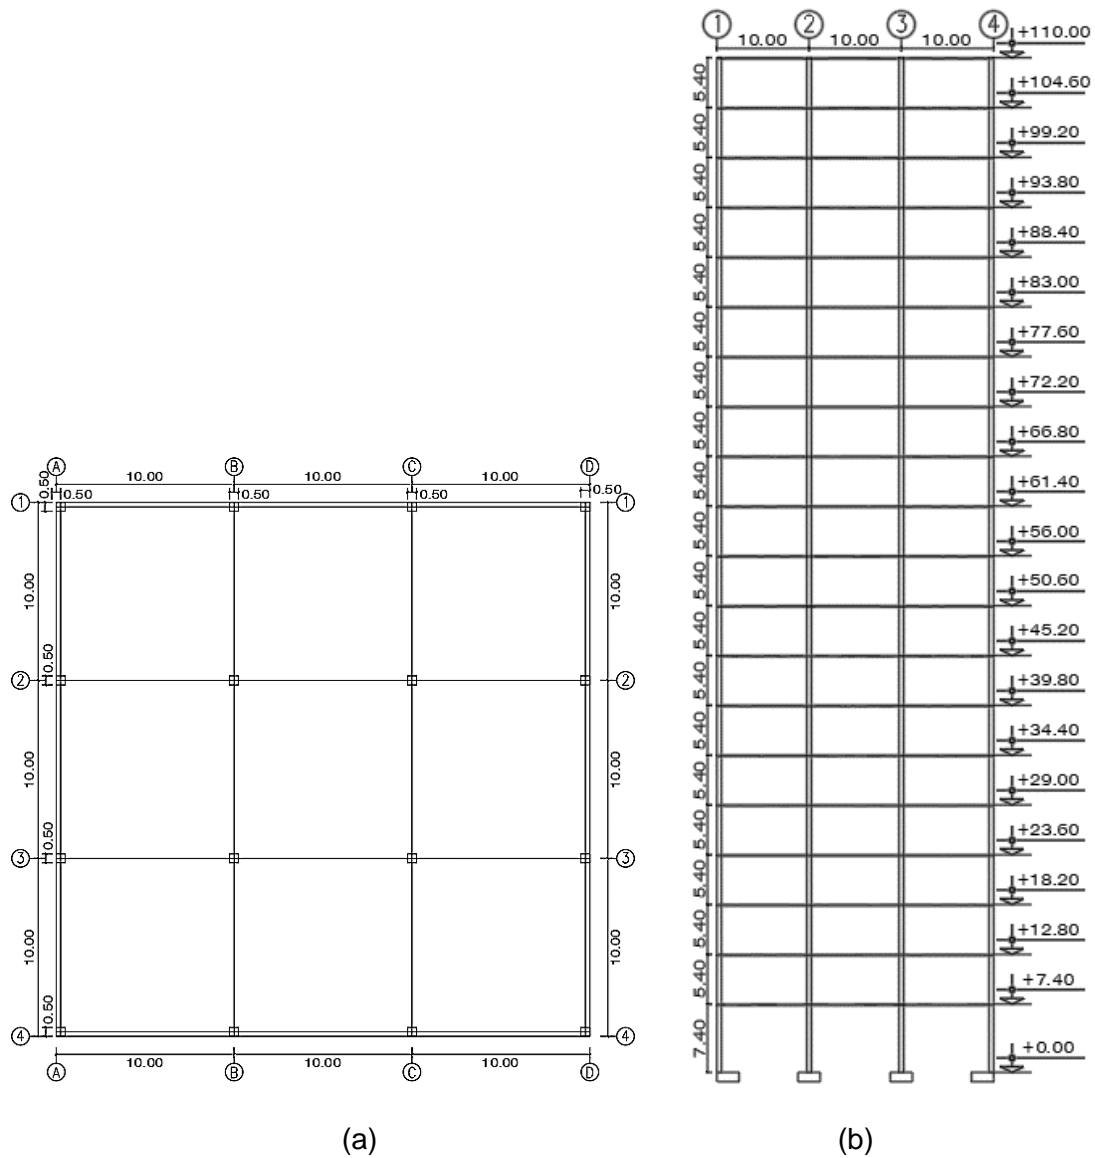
(a) Planta típica, (b) Elevación del nivel 1 al 20.
